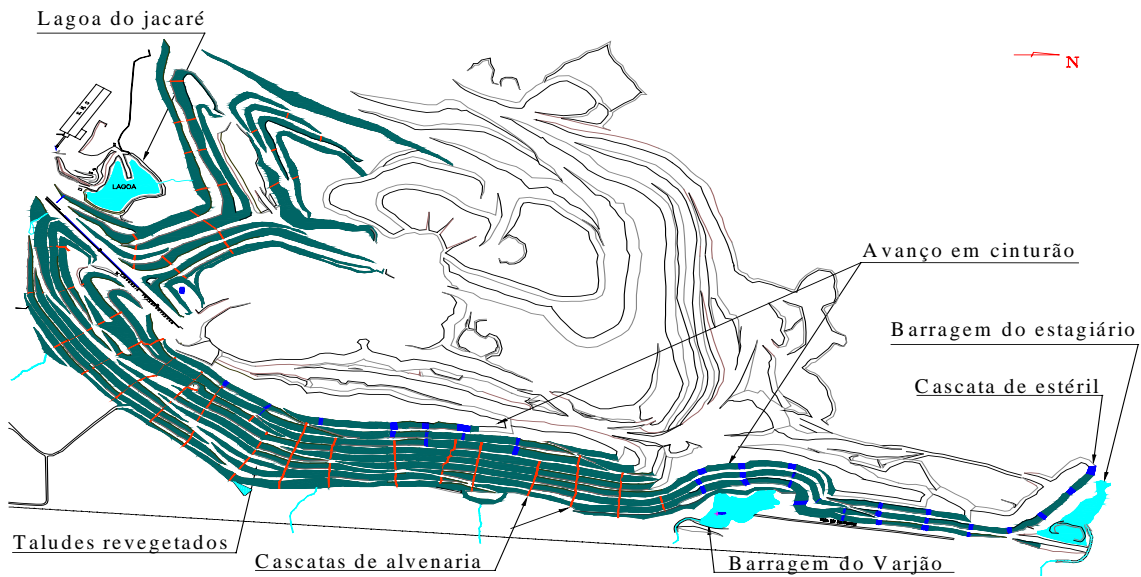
Plano de construção da pilha de bota-fora de estéril e rejeito
